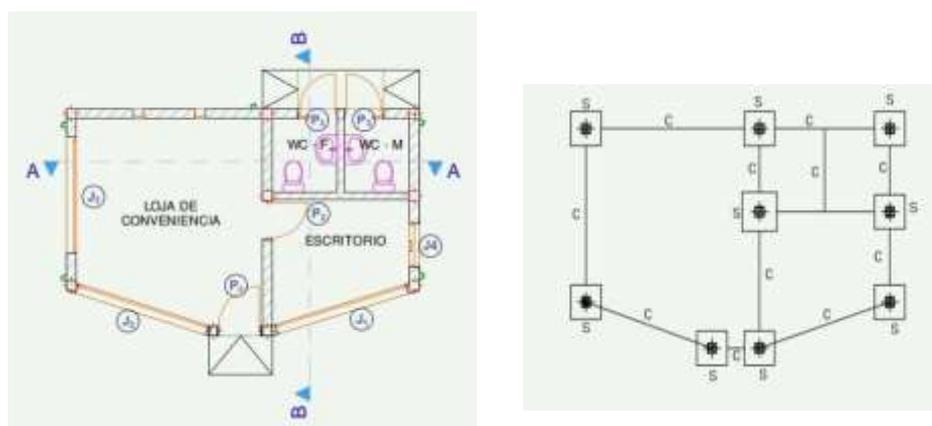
Planta arquitectónica e estrutural da loja de conveniências (Fonte: Projecto do PAC).
